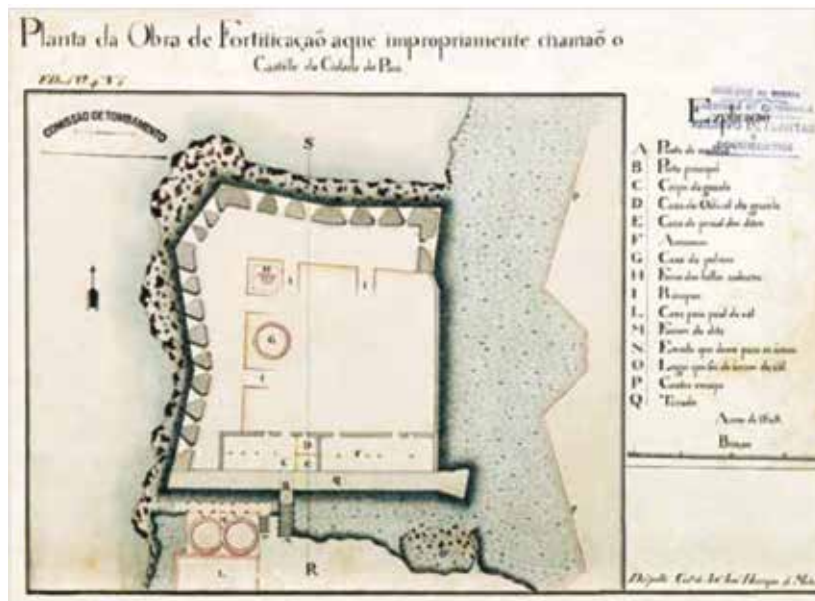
Planta da Obra de Fortificação, século XVIII.
